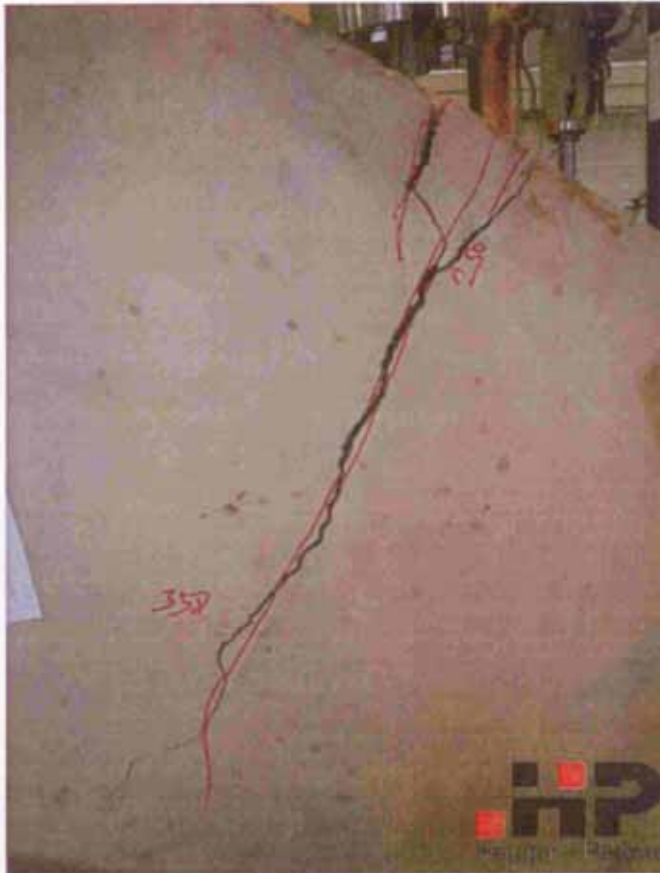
Versuchsende bei stark klaffendem Biegeriss – kein Betonausbruch
